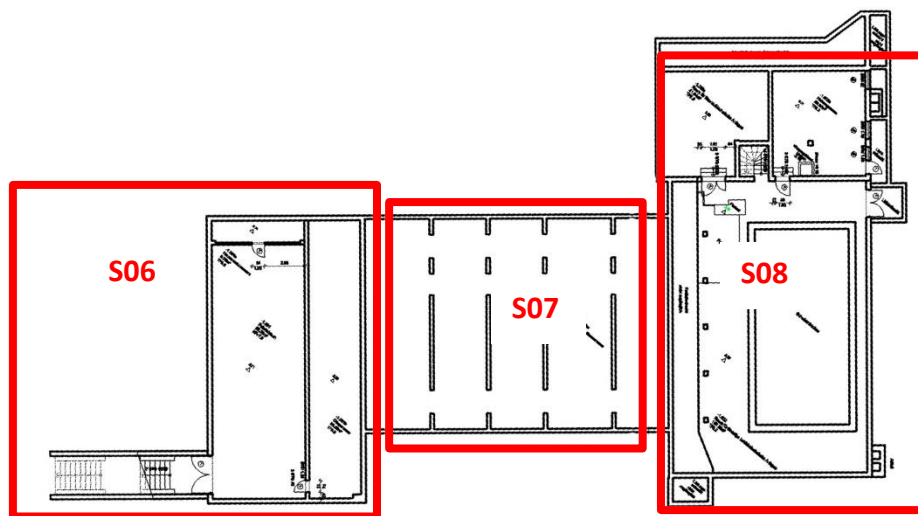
Grundriss Kellergeschoss Sporthalle
